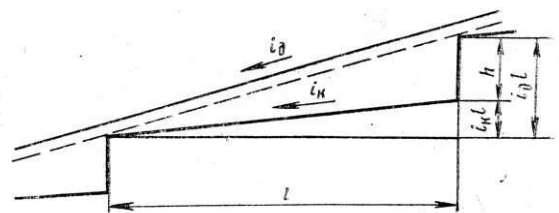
Схема к выводу формулы расстояния между перепадами на каскаде перепадов
